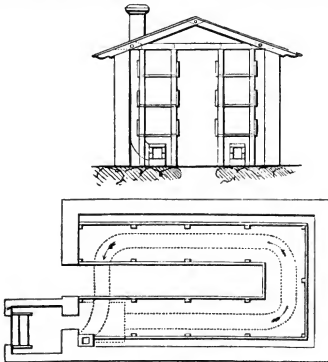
Dörrhäuschen (Aufriß und Grundriß).
